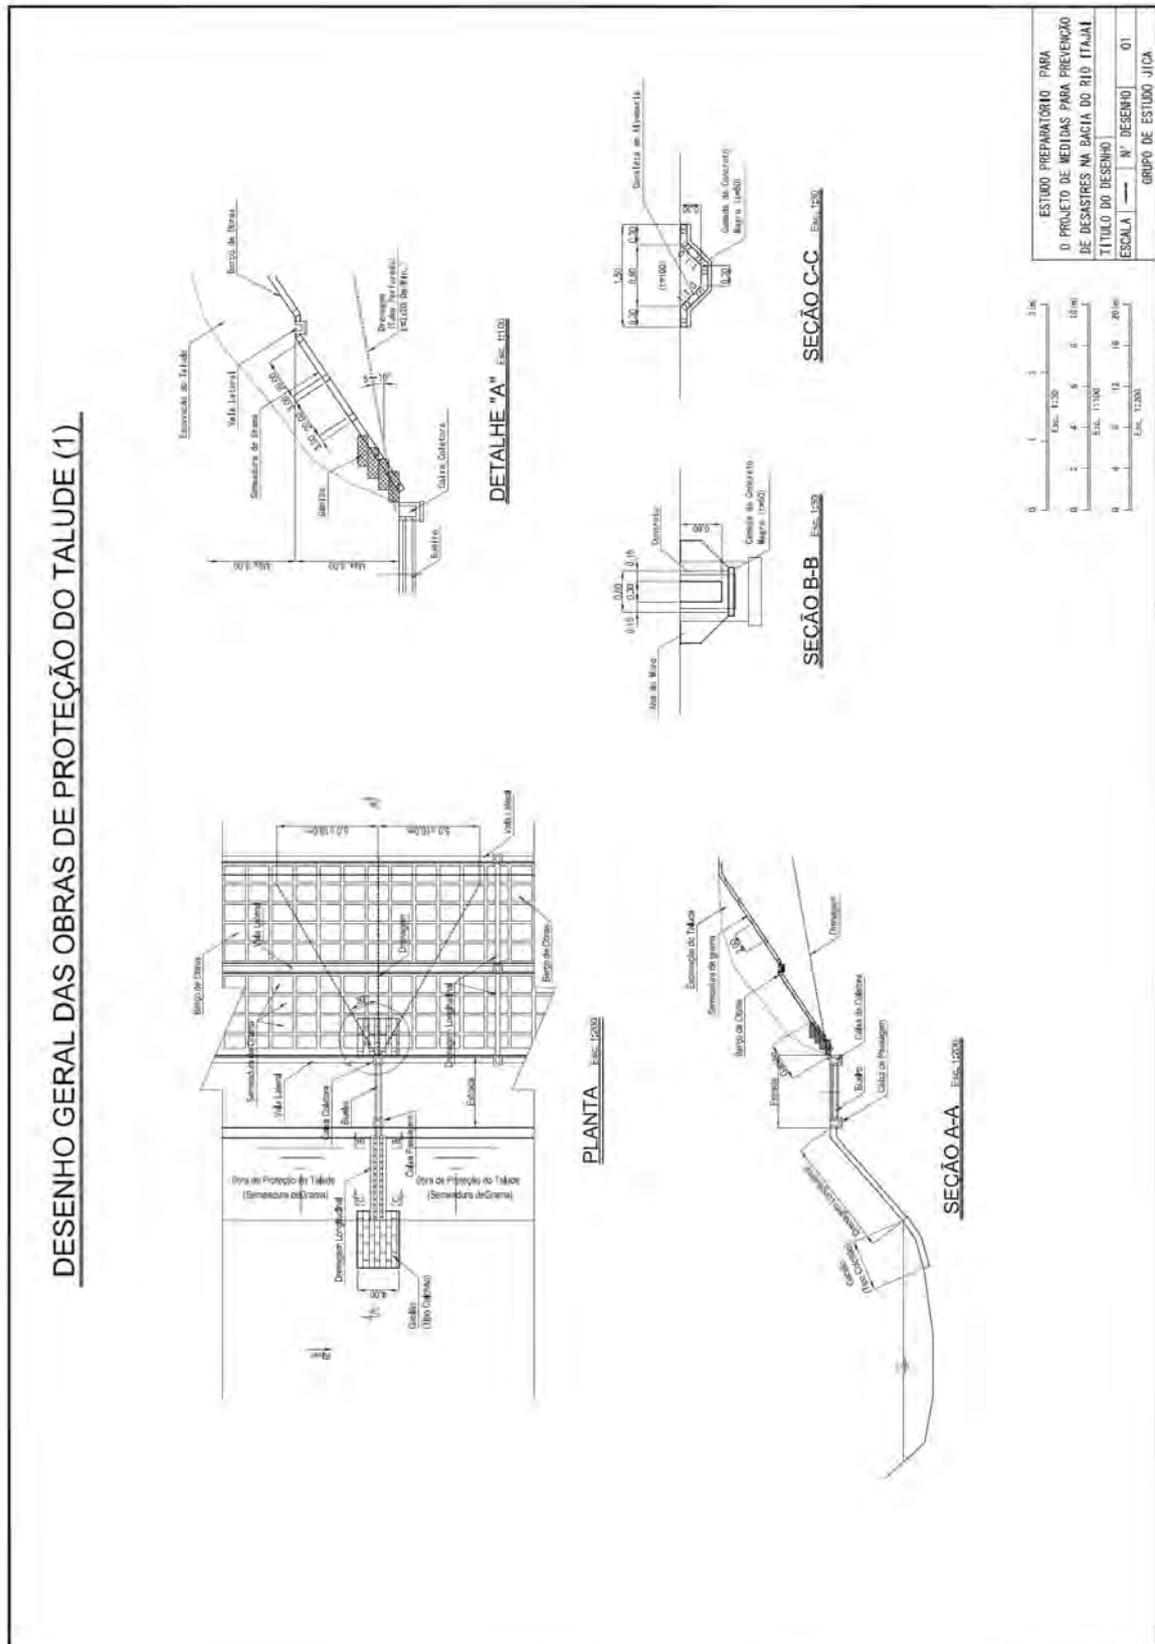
Projeto estrutural da obra de estabilização do talude (1)
